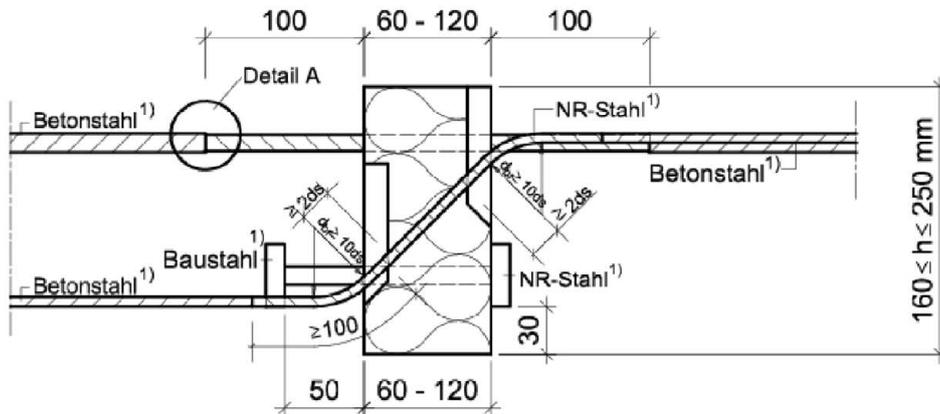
Schöck Isokorb® Typ K-ID mit Stahldrucklager in eingebautem Zustand mit Aufhängebewehrung und Vergussfuge
